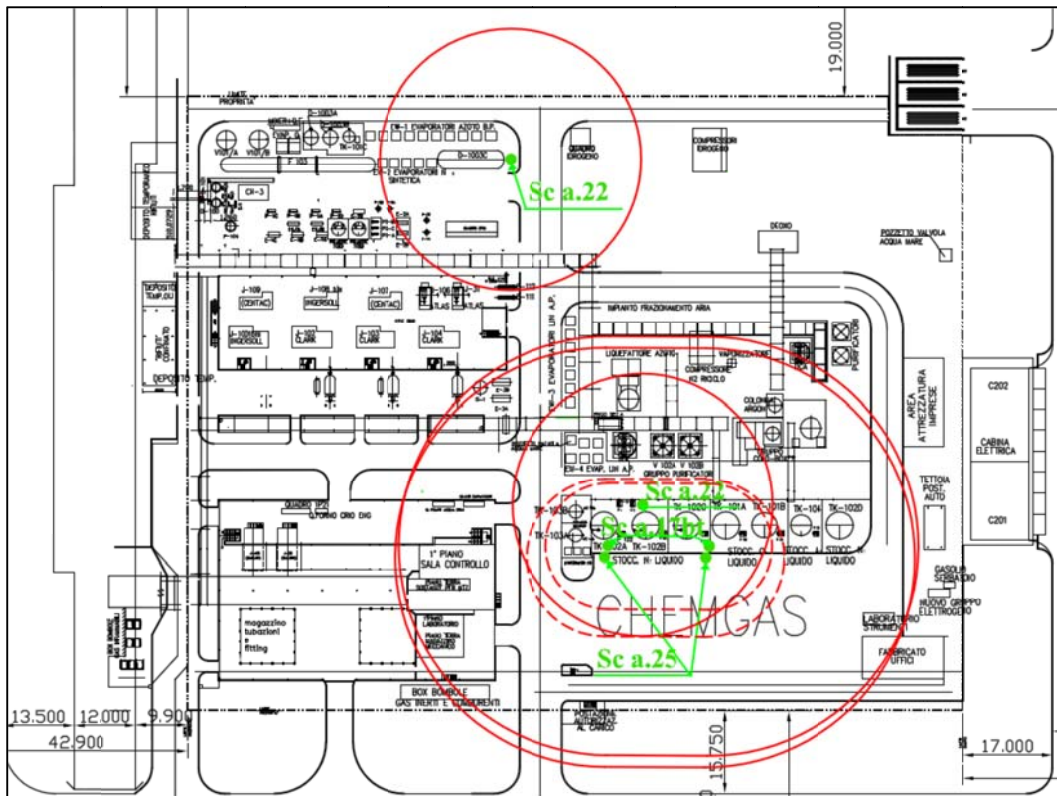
Stralcio della Planimetria limiti proprietà impianto – Dispersione Azoto Rottura Totale D5
